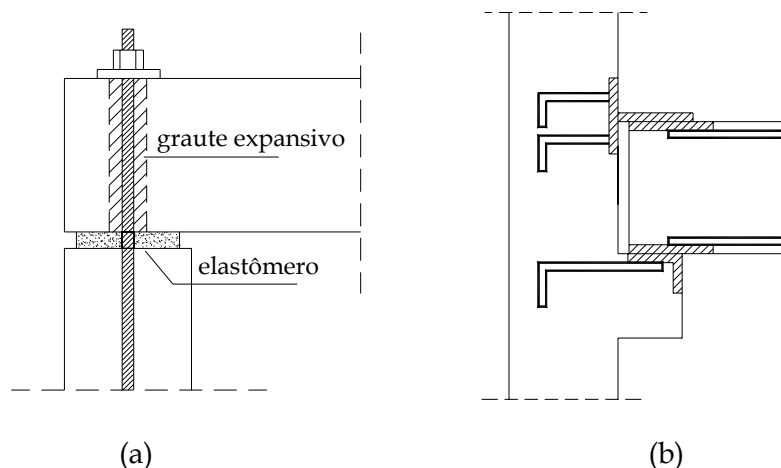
Ligações viga-pilar estudadas por FERREIRA (1999):
